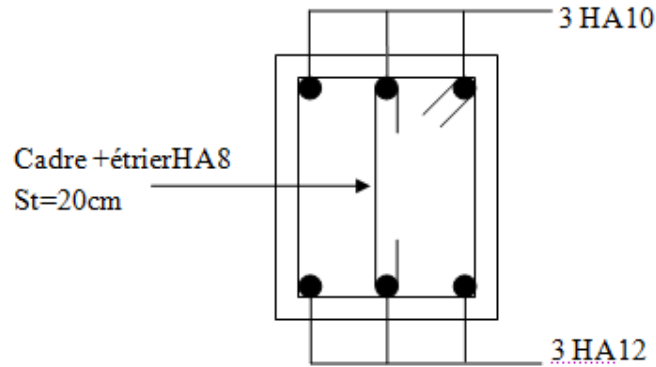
Schéma de ferrailage de la poutre de chaînage type II.
